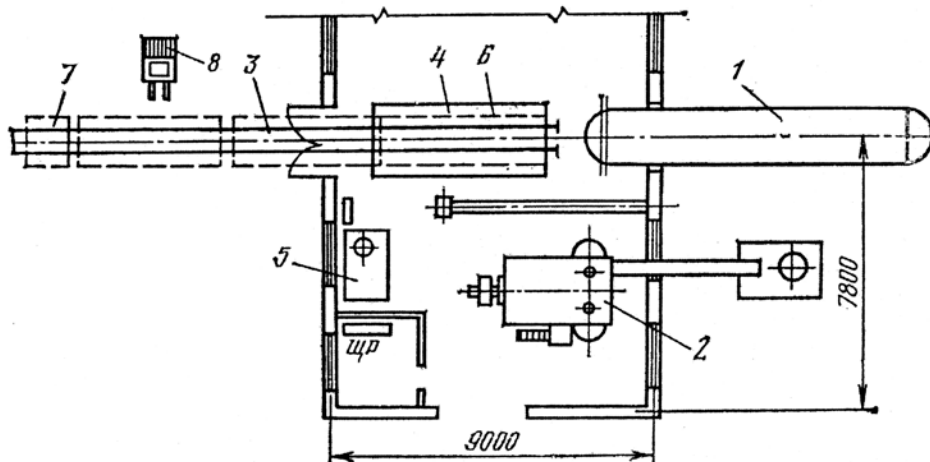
План кормоцеху для гідробаротермічної обробки соломи в автоклаві: 1 – автоклав; 2 – котел-пароутворювач Е 1/9; 3 – рейки для платформи; 4 – пересувна платформа; 5– резервуар для води; 6 – установка для зволоження тюків шприцюванням; 7 – платформа з електроприводом; 8– автозавантажувач.
